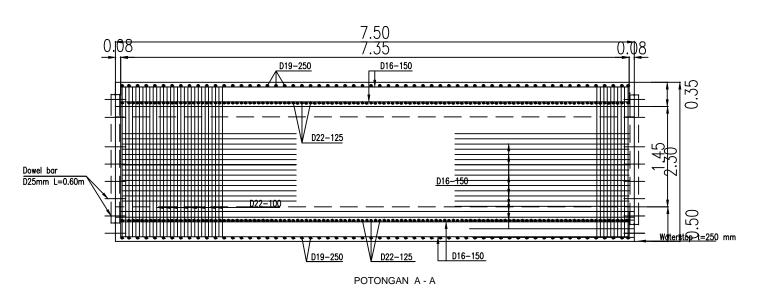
DETAIL PENULANGAN KONDUIT PENGELAK TIPE A
